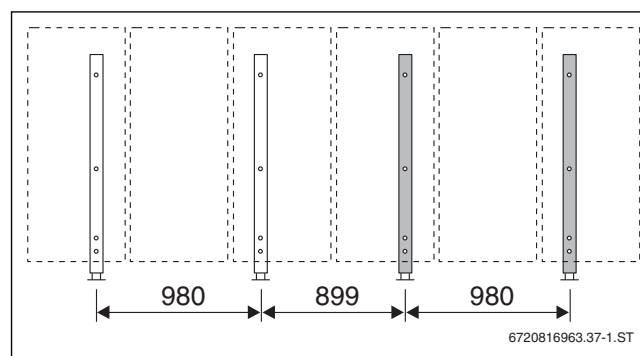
Základní provedení pro 3 kolektory, údaje v mm
